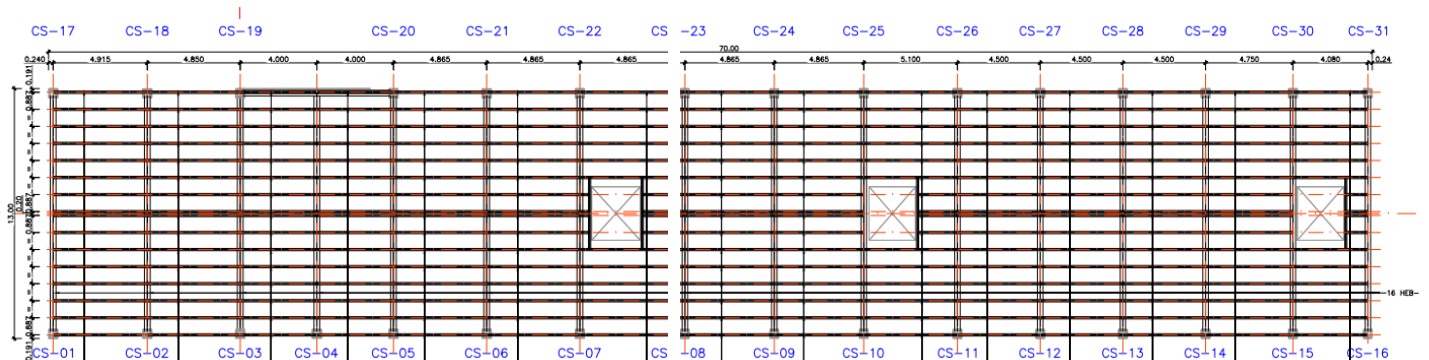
Vue en plan de la toiture de la passerelle SNTF
